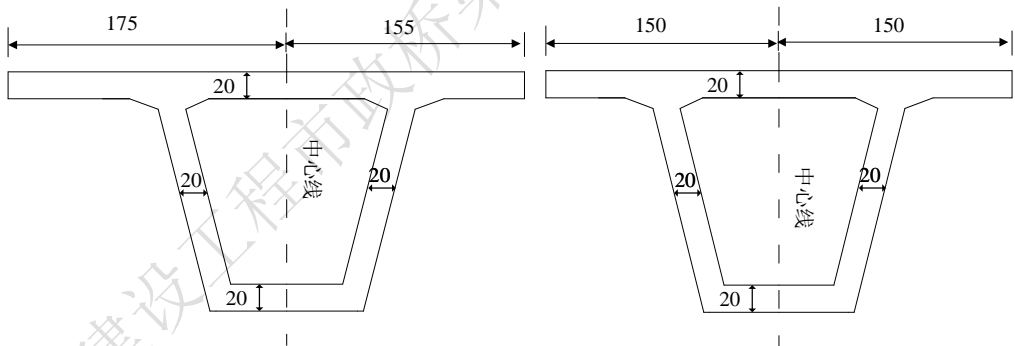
箱梁 1/2 纵向剖面图（单位：cm）
